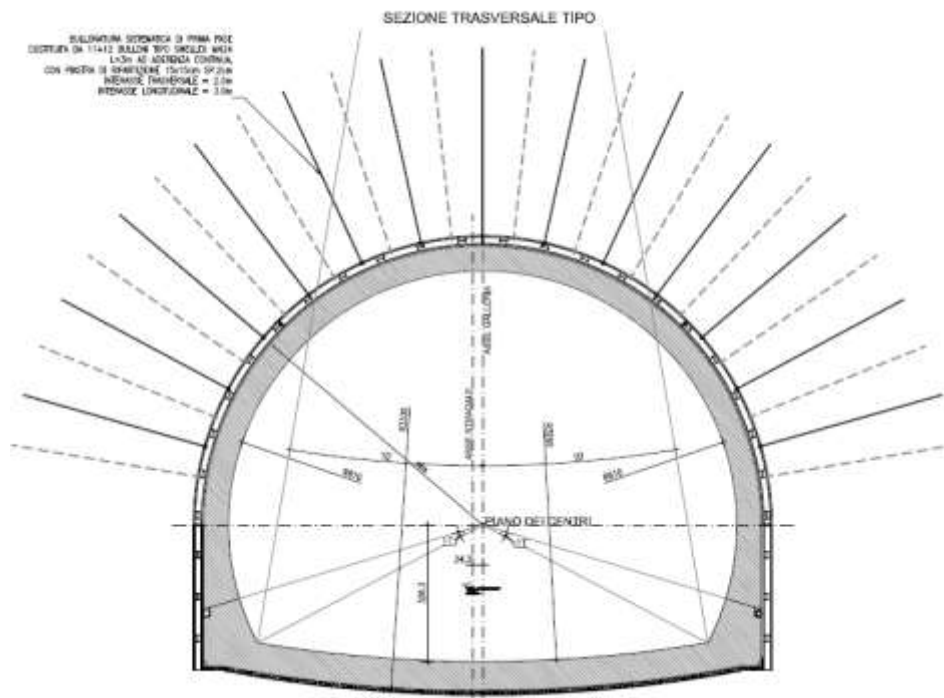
Dettaglio relativo alla configurazione di sezione “Medium”
